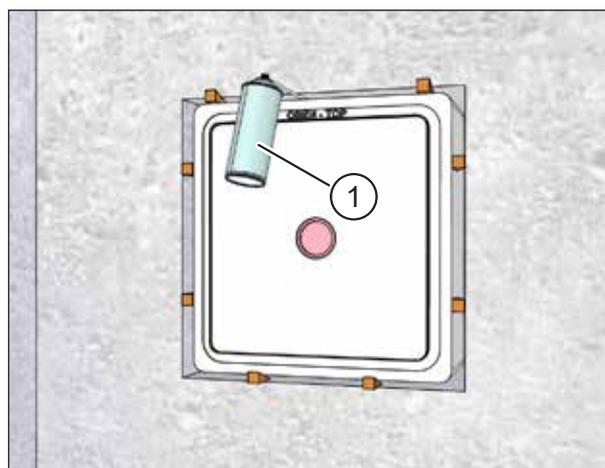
Garnir de mousse les espaces creux autour du caisson mural
